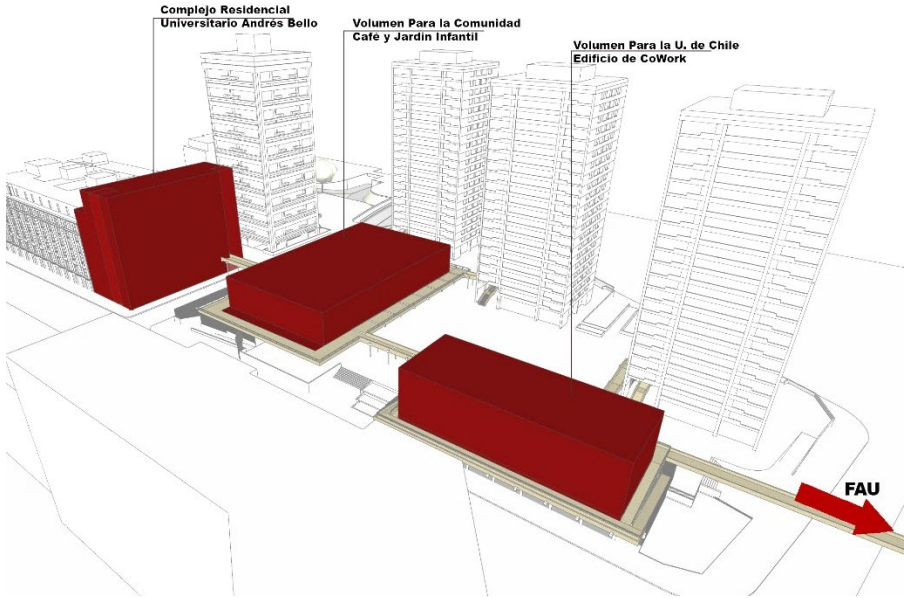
Propuesta Recorrido Pasarelas Verdes
